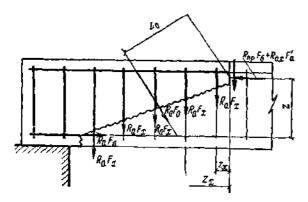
Схема усилий в сечении, наклонном к продольной оси железобетонного элемента, при расчете его по прочности на действие изгибающего момента
